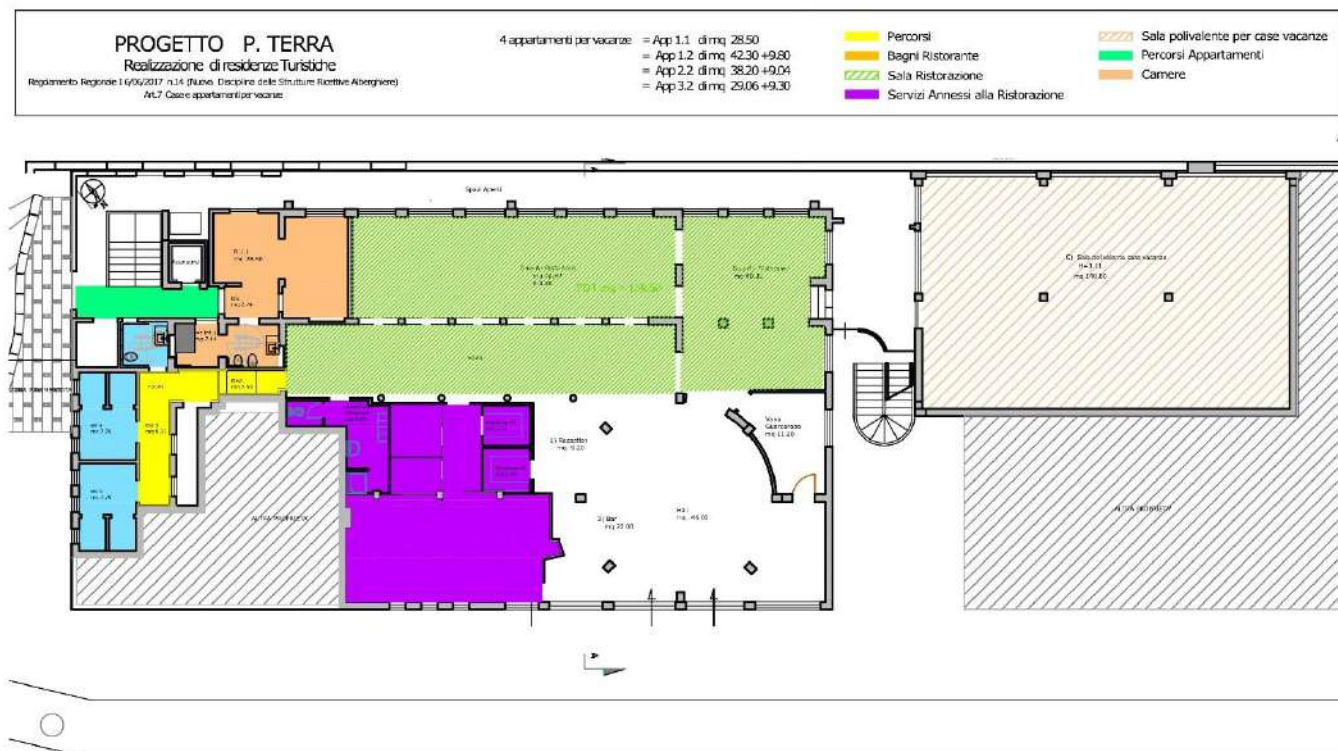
Individuazione Superfici P.T./P1° - Stato Progetto
